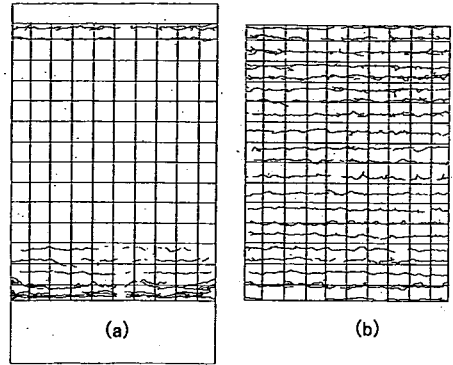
非岩着試験体のひび割れ状況（東側壁）
